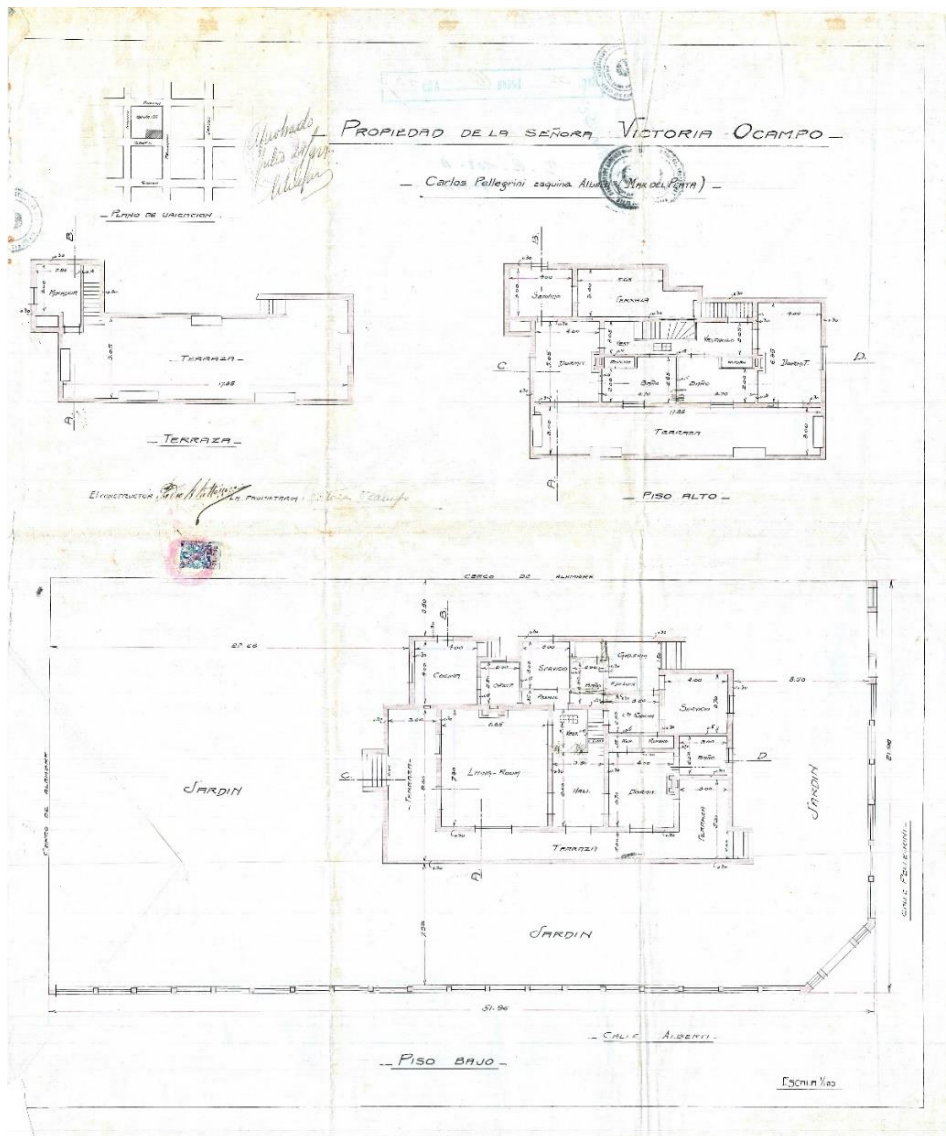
Progetto di Victoria Ocampo, planimetrie 'Casa Cubo', Mar del Plata, 1927.
